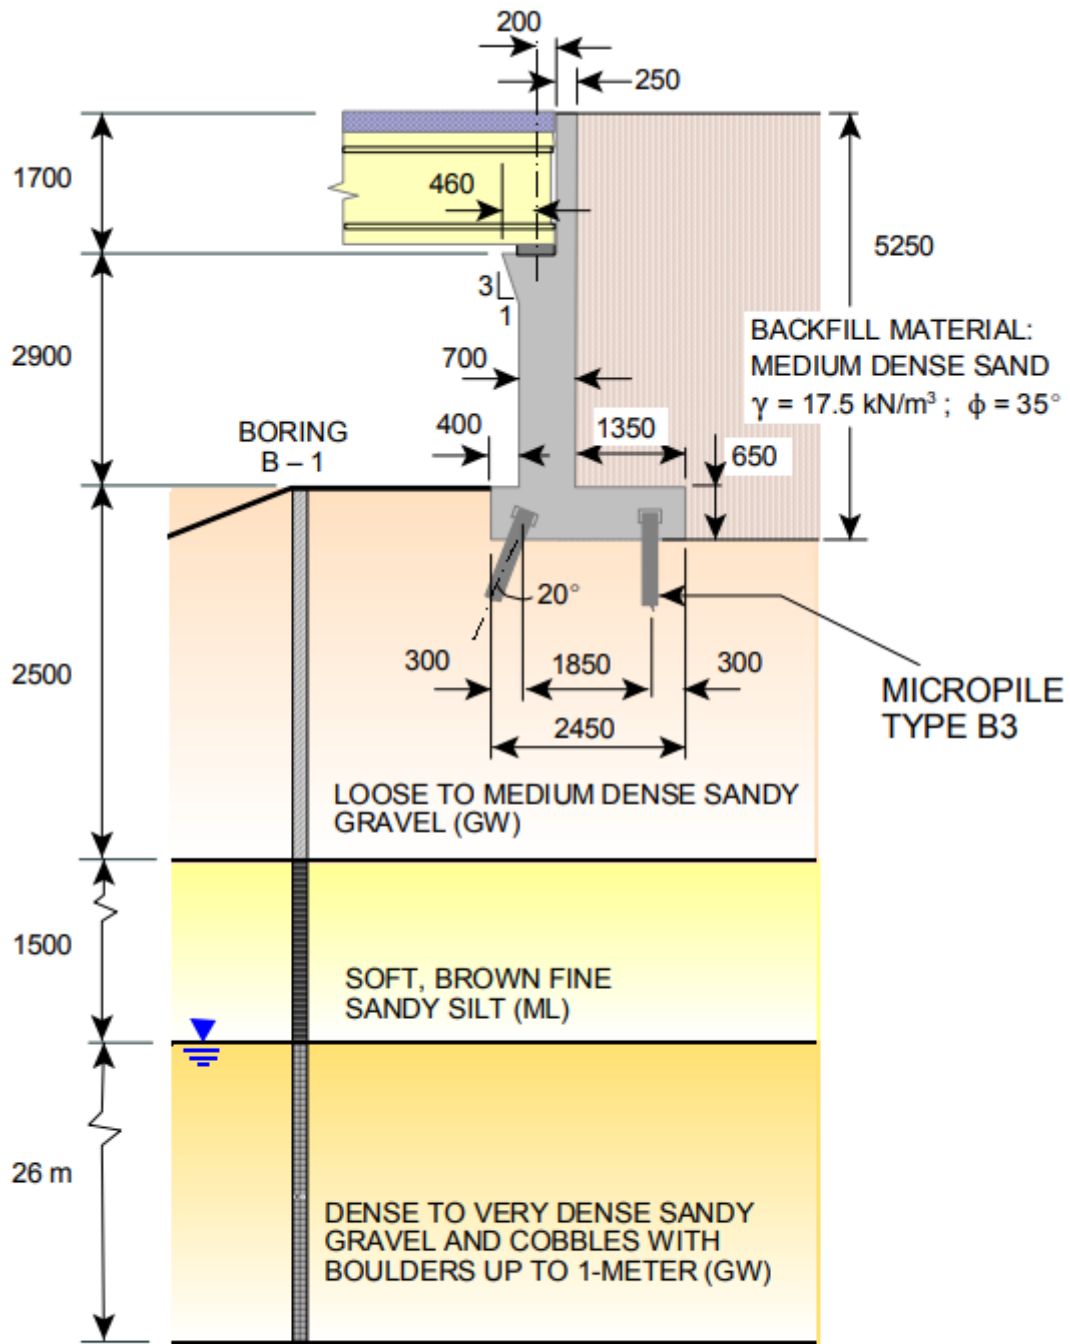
Ejemplo N°1 - Detalle de la sección del pilar (Todas las dimensiones en mm)
